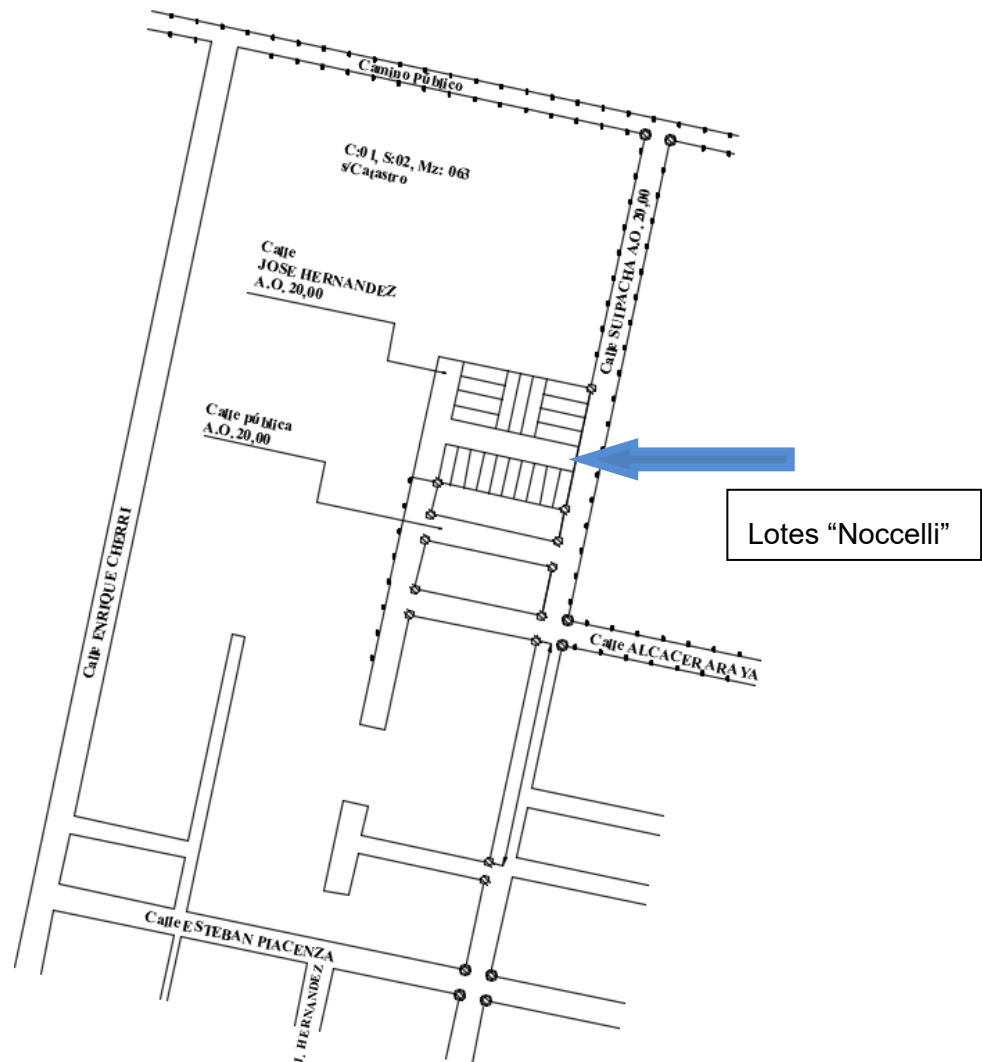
Plano de subdivisión y disposición de los lotes.
